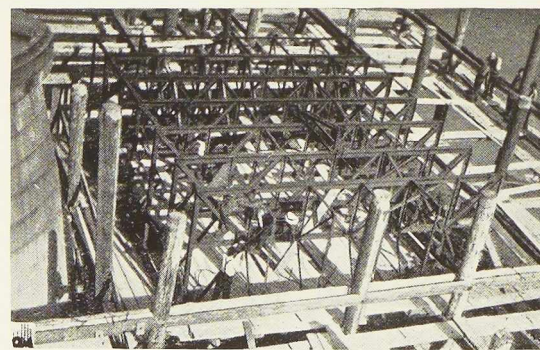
Montage à pied d'œuvre d'un caisson de pile du pont-route Marguerite.
